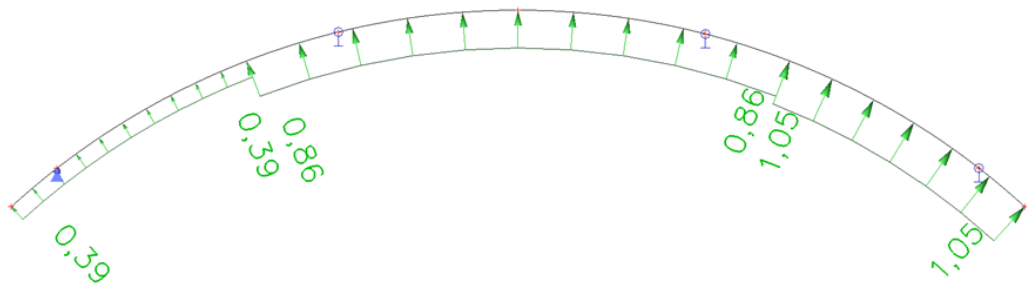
Zatížení střešní konstrukce - vítr příčný zleva
